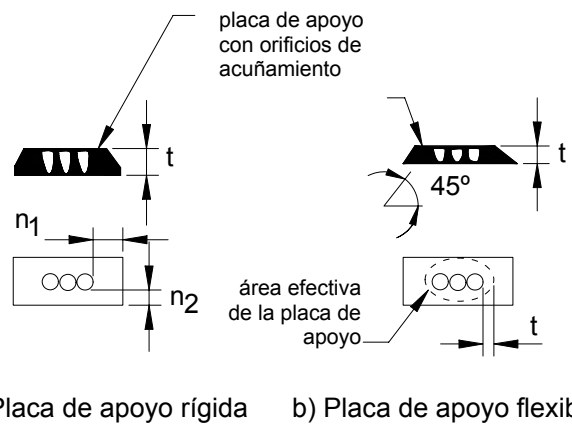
Área efectiva de la placa de apoyo para dispositivos de anclaje sin placa de acuíñamiento separada
